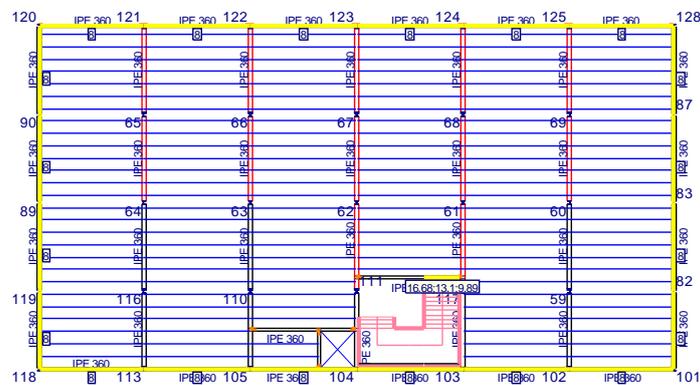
Vista del forjado (Fuente: CypeCad)
